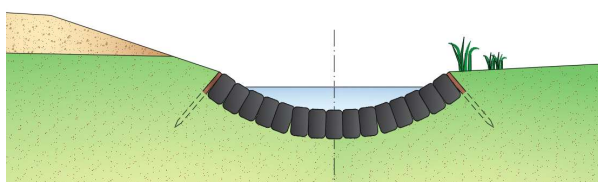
Możliwe elementy systemu odwodnienia dróg
